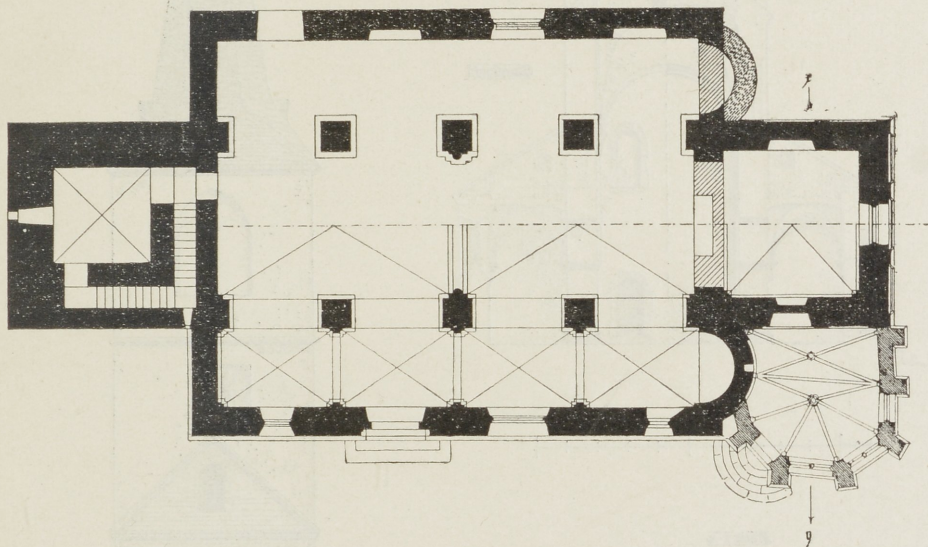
Niedermendig. Grundriss der alten katholischen Pfarrkirche.
